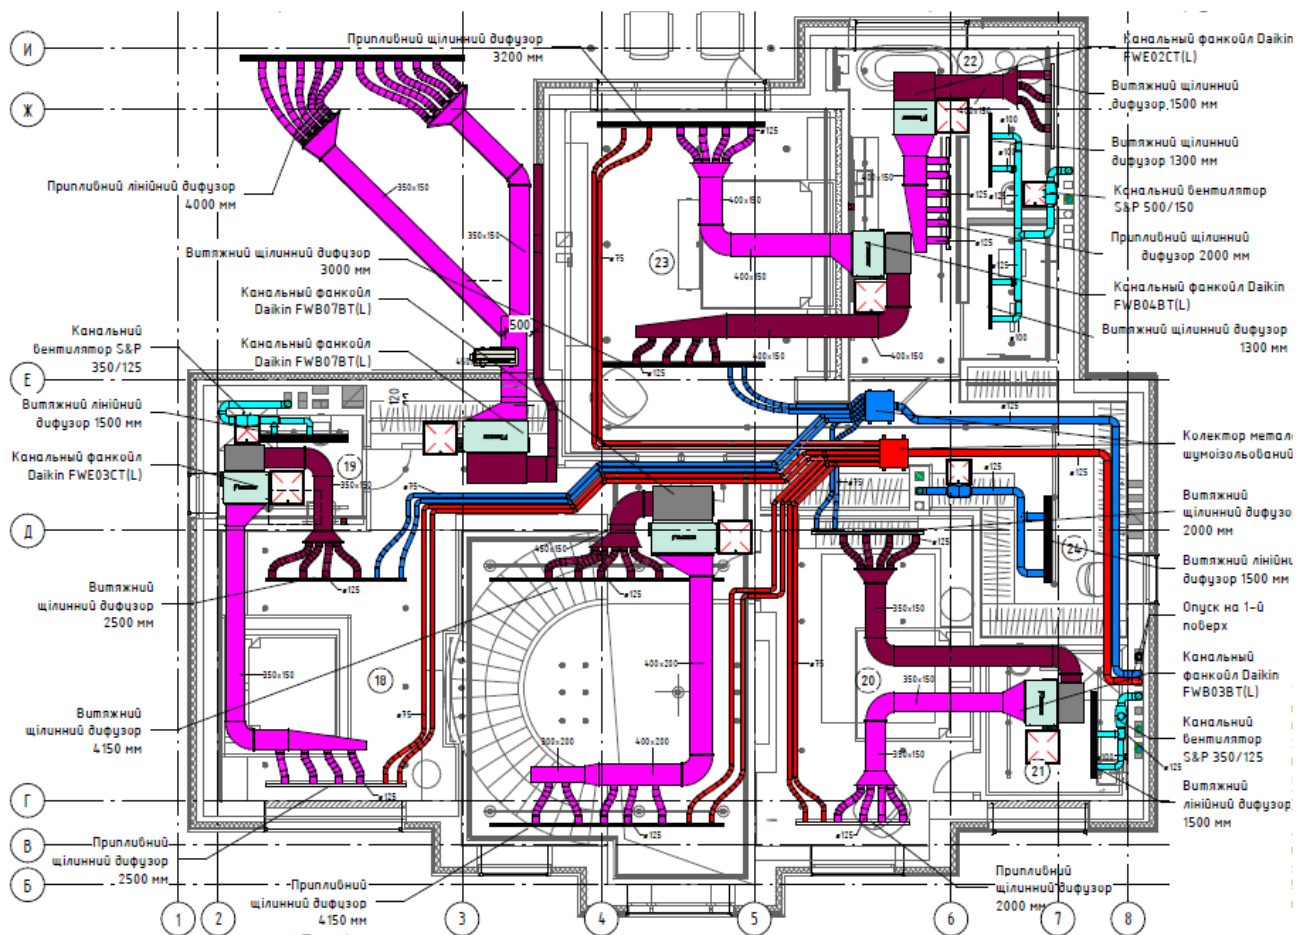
План 2-го поверху. Система вентиляції та охолодження
